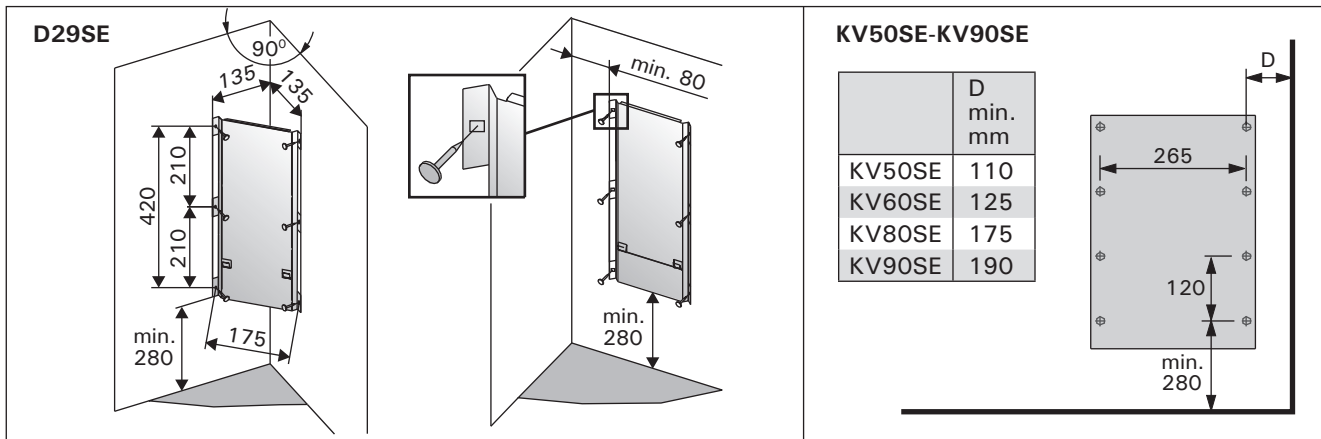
Ubicación del bastidor de montaje del calentador (todas las dimensiones en milímetros)
